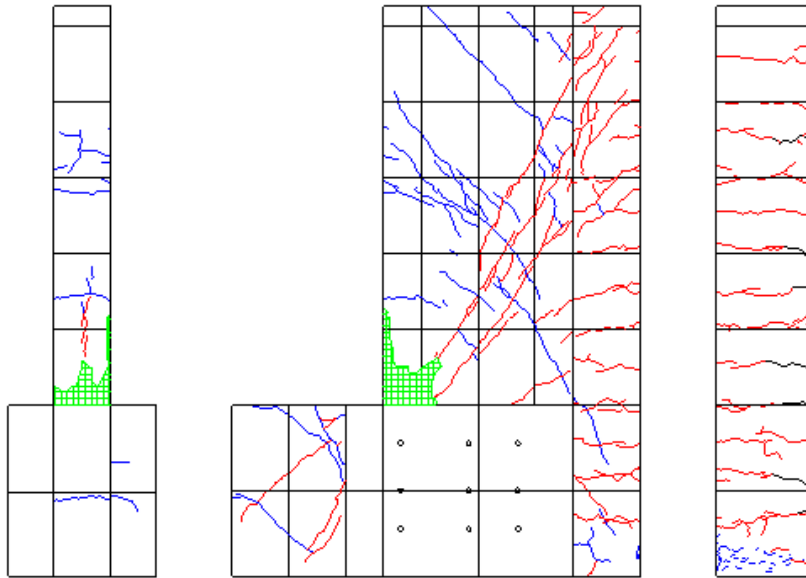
R=1/33 ひび割れ図
